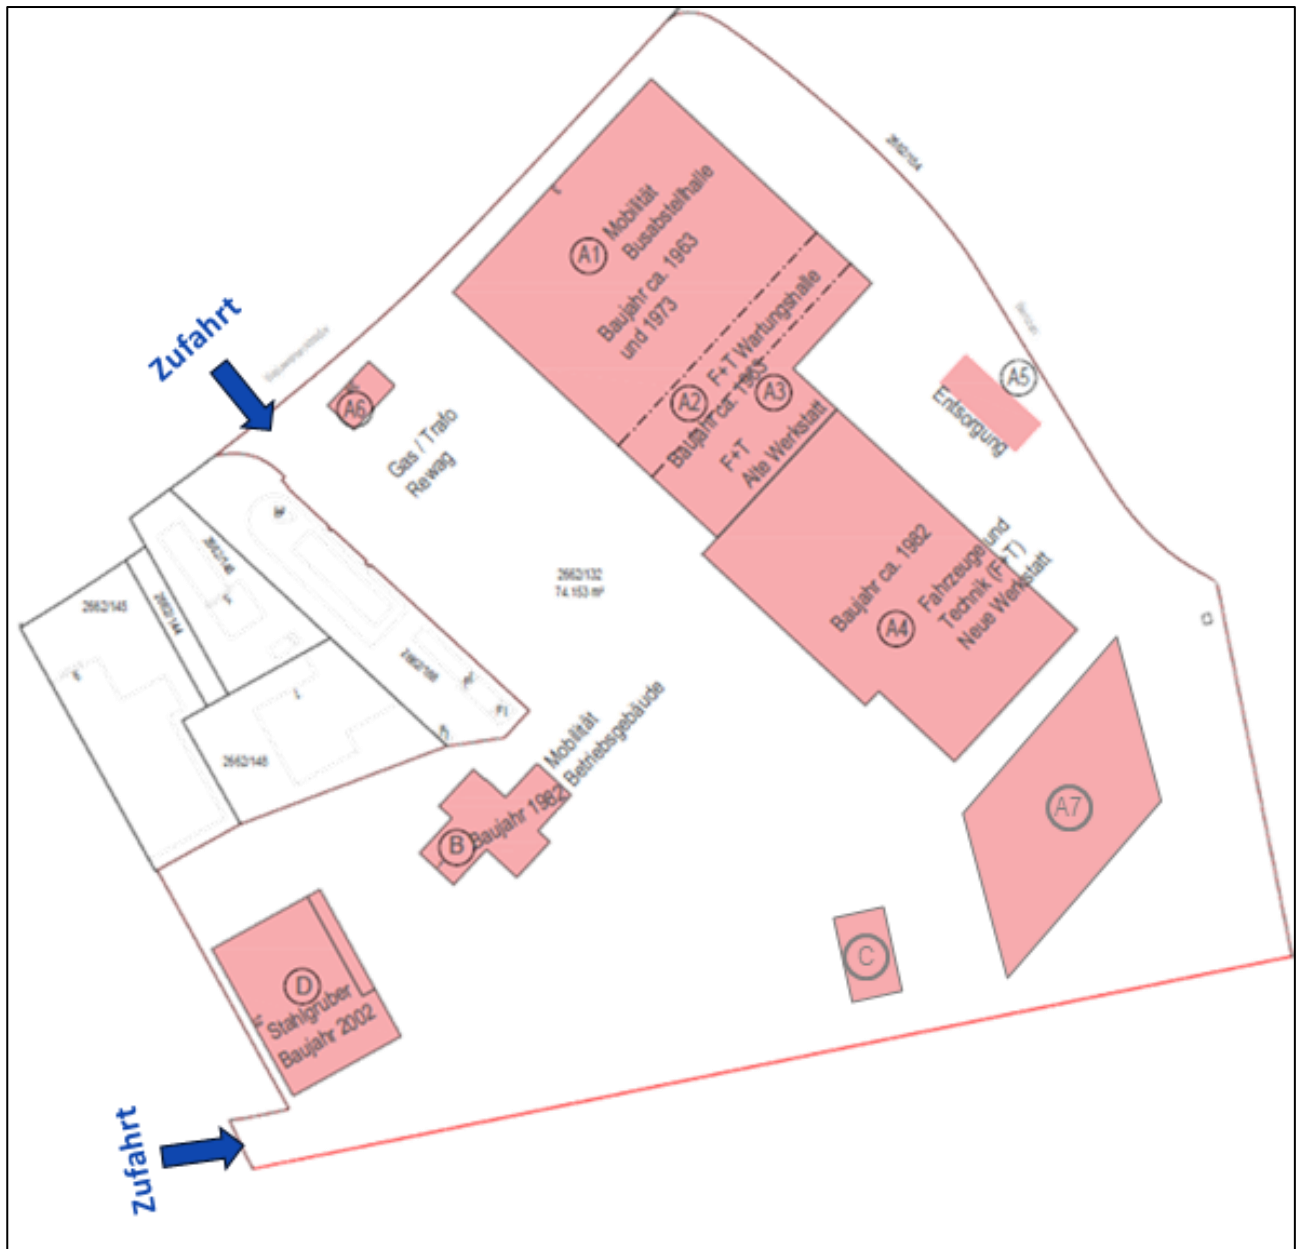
Lageplan Areal Markomannenstraße mit Bauteilen
